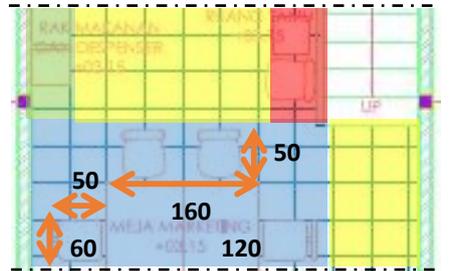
Ruang Kerja Lantai 1 Objek B
